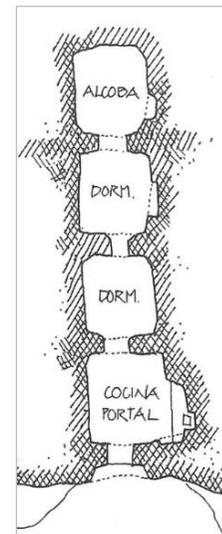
Vivienda excavada en fondo (Jové, 2006)
